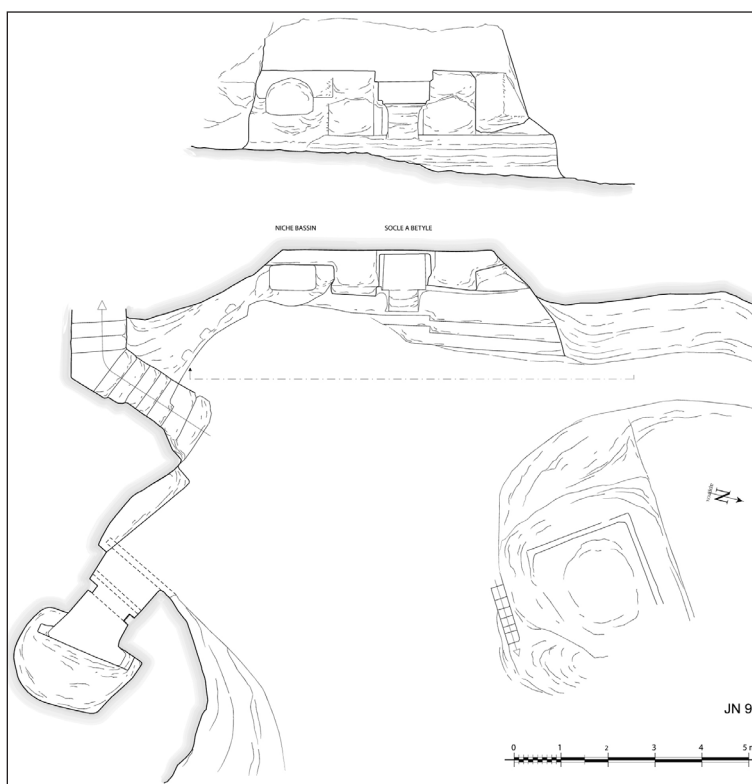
Complexe JN 9 : relevés en plan et en coupe (© MAFP, S. D.).
